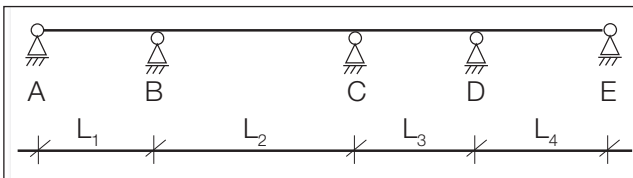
Berücksichtigung der Durchlaufwirkung bei der Ermittlung von Deckenauflagerkräften von einachsig gespannten Decken.
